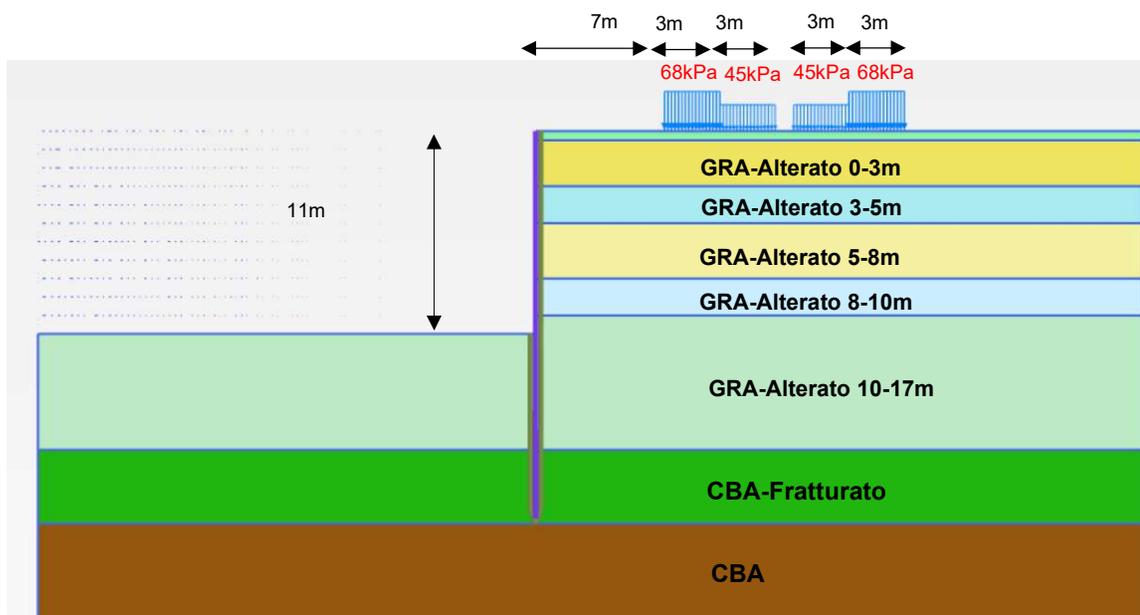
Intervento di stabilizzazione della S.S 100 (GA-02)
